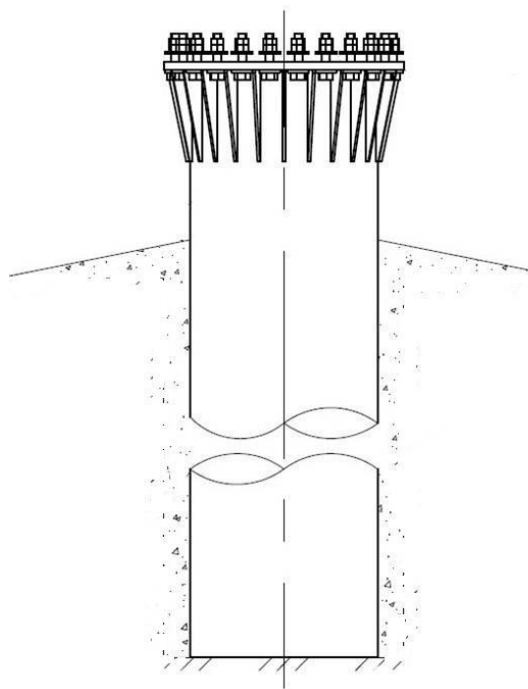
Фундамент из вибропогружаемой сваи-оболочки. Схема установки.
